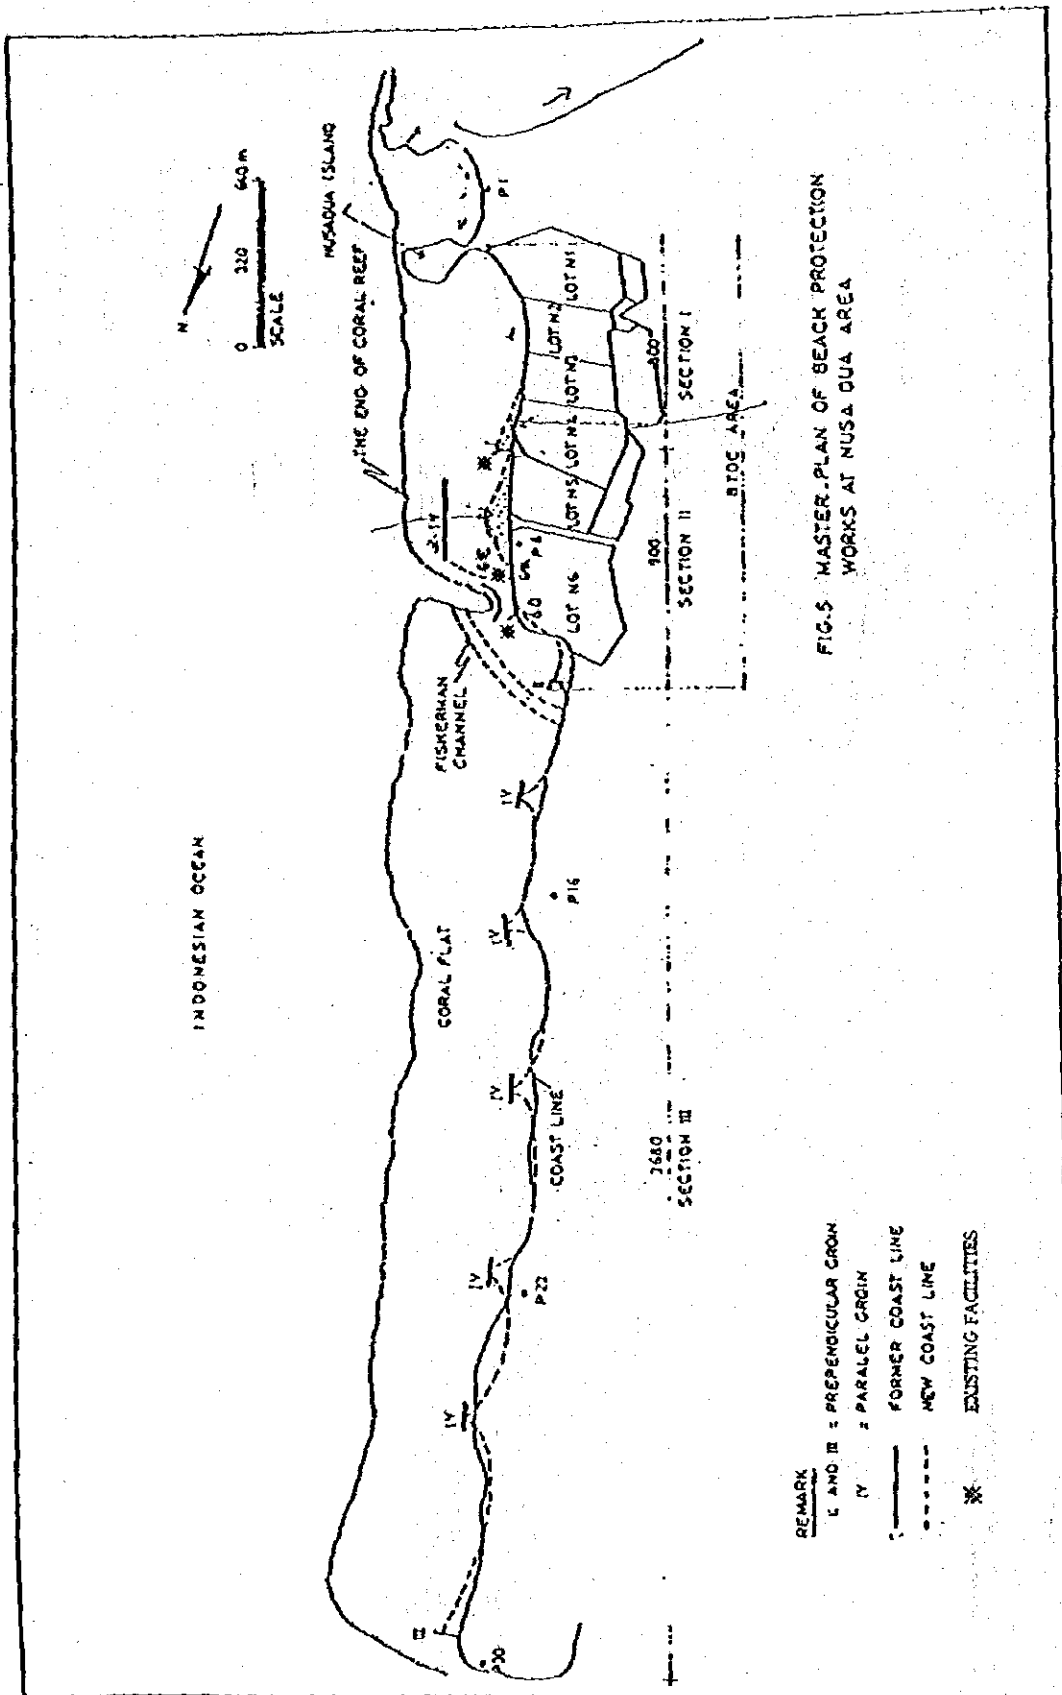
ヌサ・ドゥア海岸保全施設配置図及び施設配置計画図
